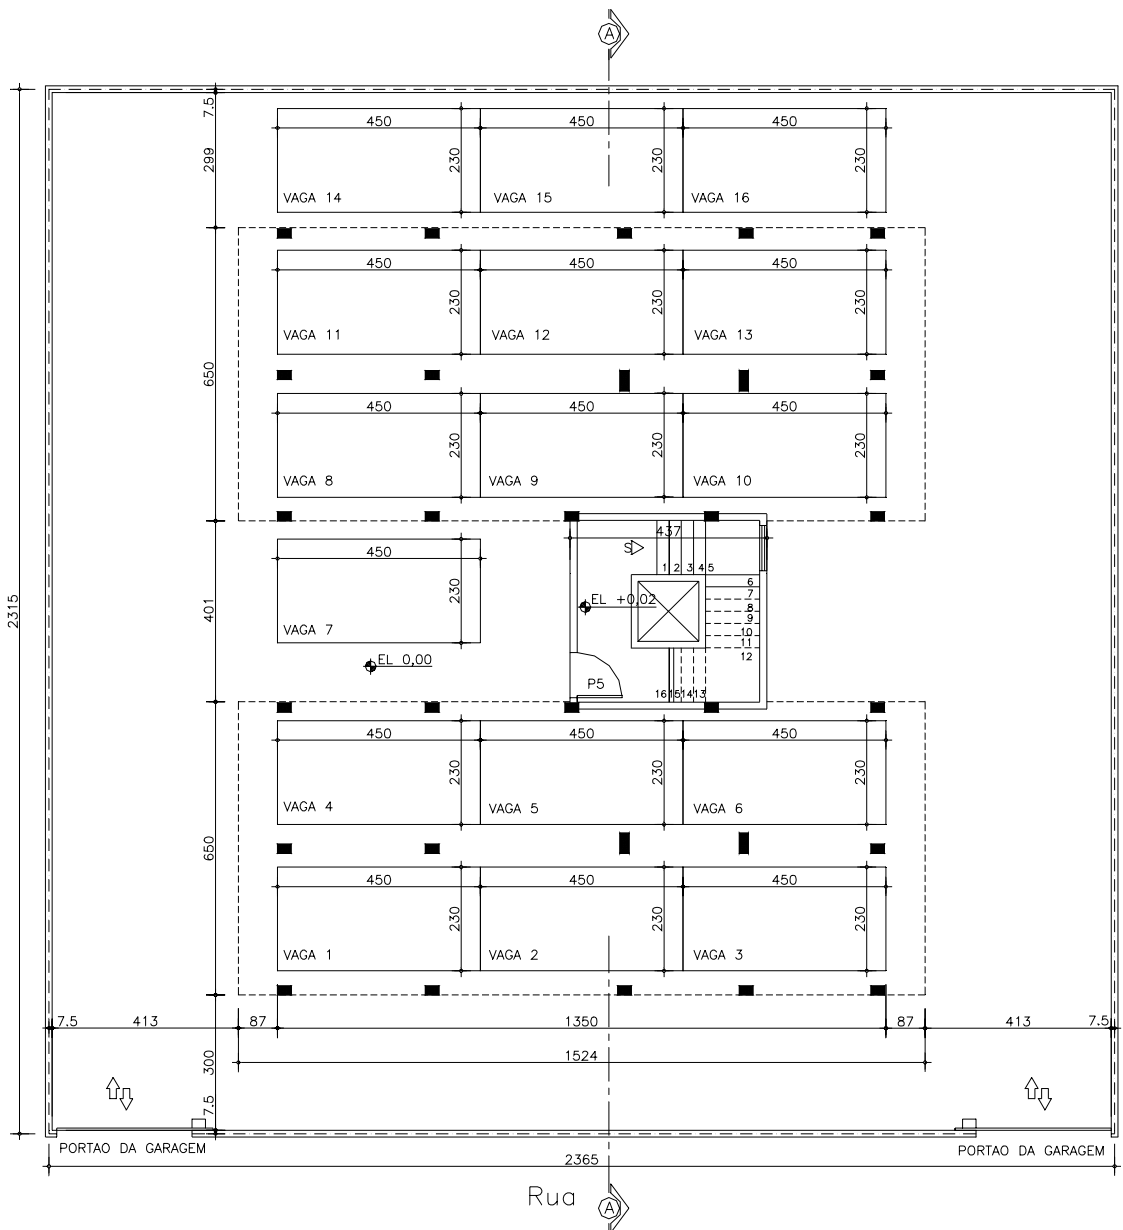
Prédio “A” – Opção 1 – Planta da Garagem
